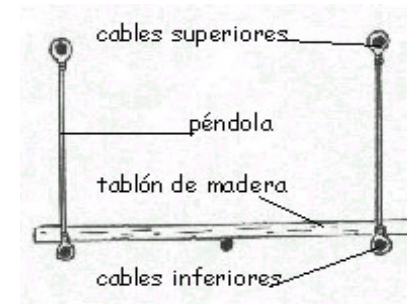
Sección transversal tipo. Ingrid Raventós (2000).
